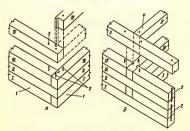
Схемы сопряжения брусьев наружных (а) и наружной внутренней (б) стен на торцевых шипах: 1 и 4 — брусья наружных и внутренией стен; 2 — нагель; 3 — отверстие
